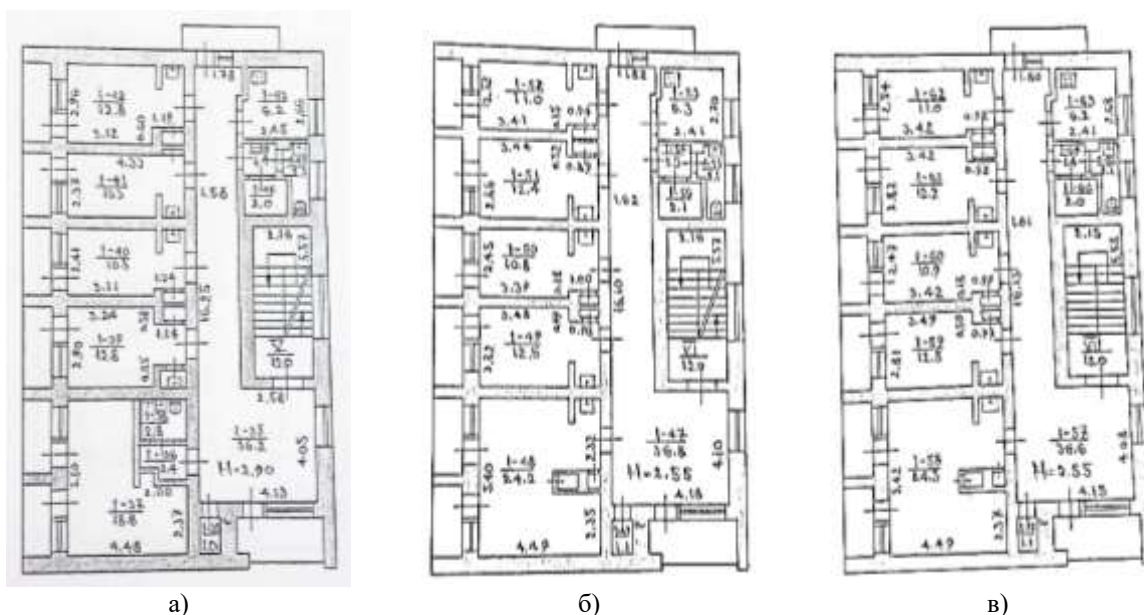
Поверхові плани будівлі: а – 1-3 поверхи; б – 4-й поверх; в – 5-й поверх
